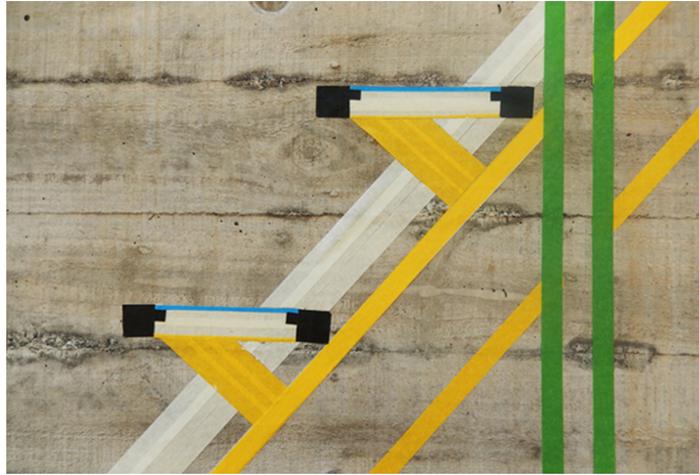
Detalle en sección de una escalera. Fuente: © Andrade, P. (2016)
